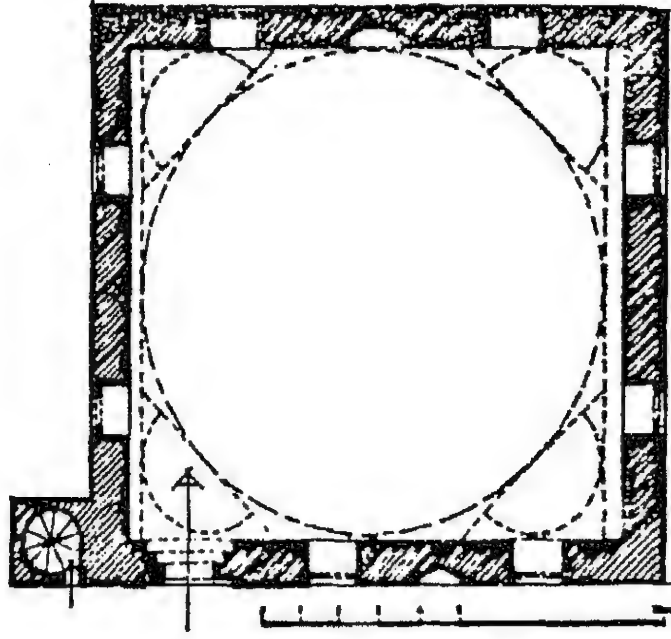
مسقط أفقي لمسجد شاه ملك في أدرنة (عن : أصلان أبا) .
